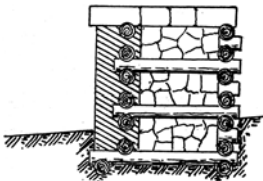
Holzsperrre mit vorgesetzter Betonwand.
